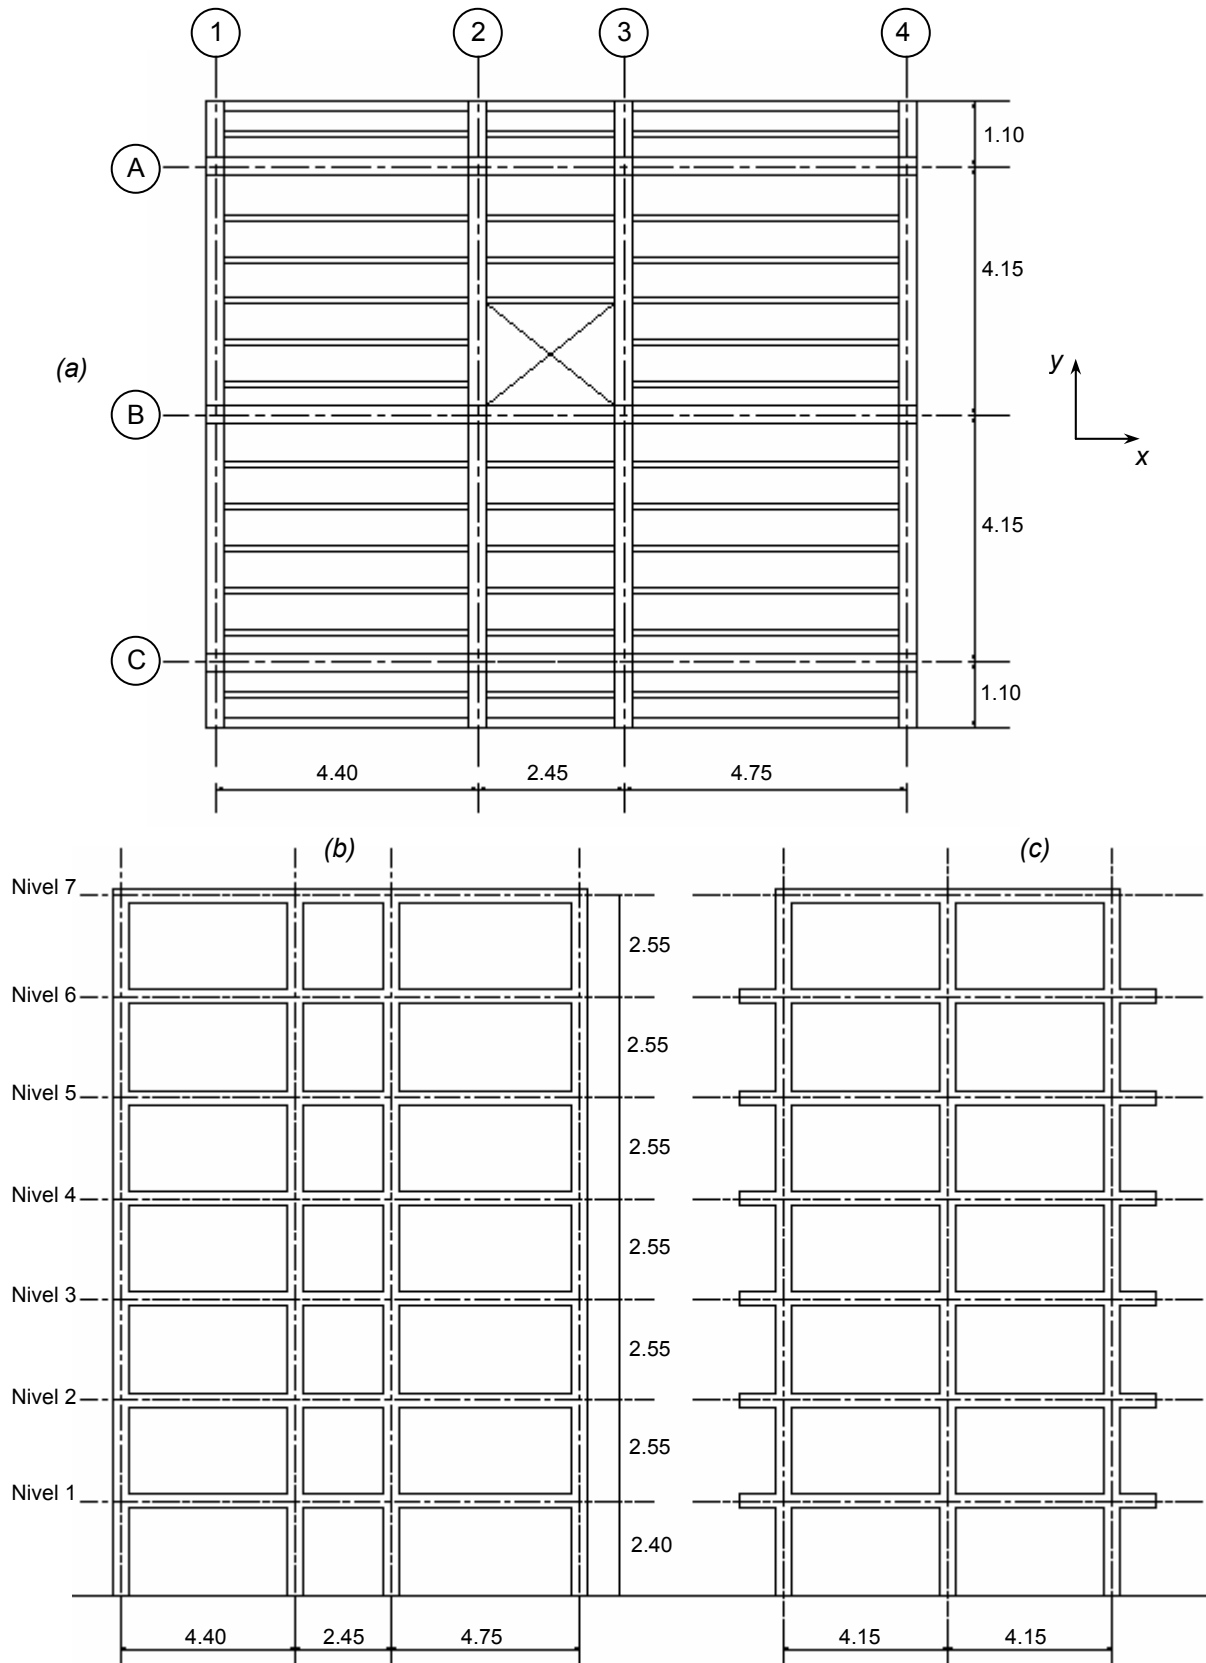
4. (a) Vista en planta de los pisos 1-6; (b) Pórticos A, B, C y (c) Pórticos 1, 2, 3 y 4
